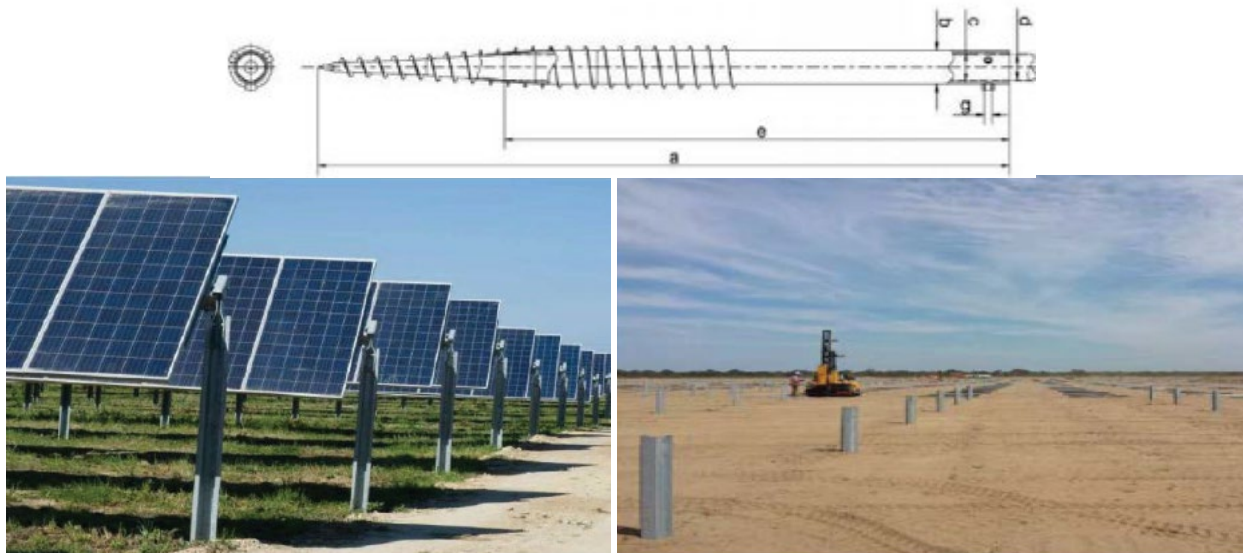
Struttura del pannello fotovoltaico e fase di infissione della struttura di fondazione.
